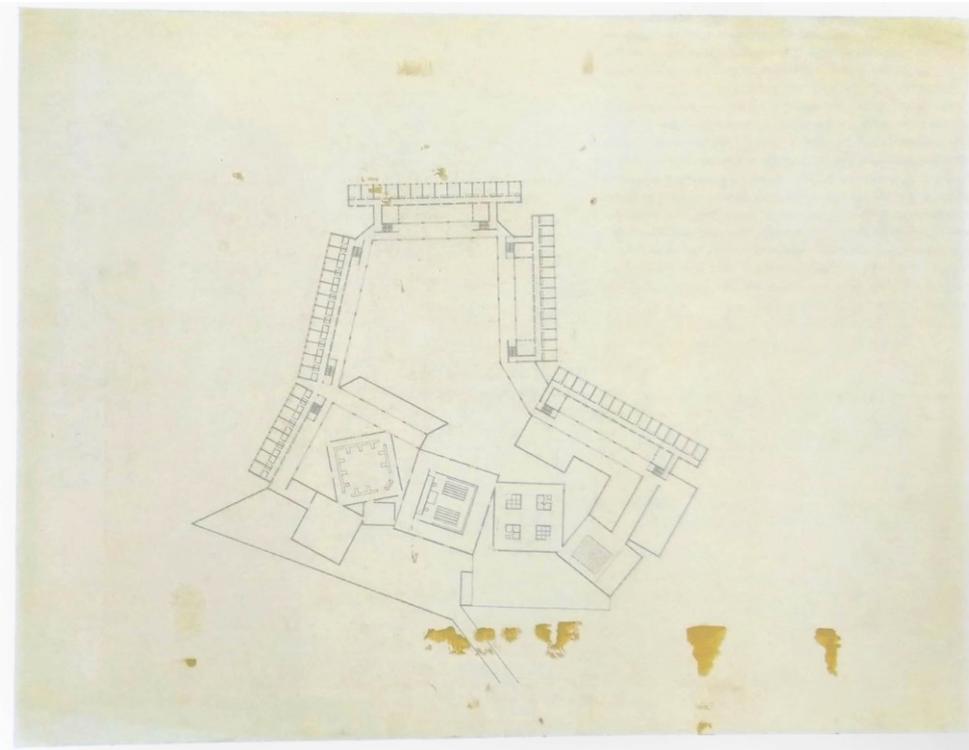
Casa-mãe Dominicana, planta baixa. Louis Kahn, outubro, 1966.
